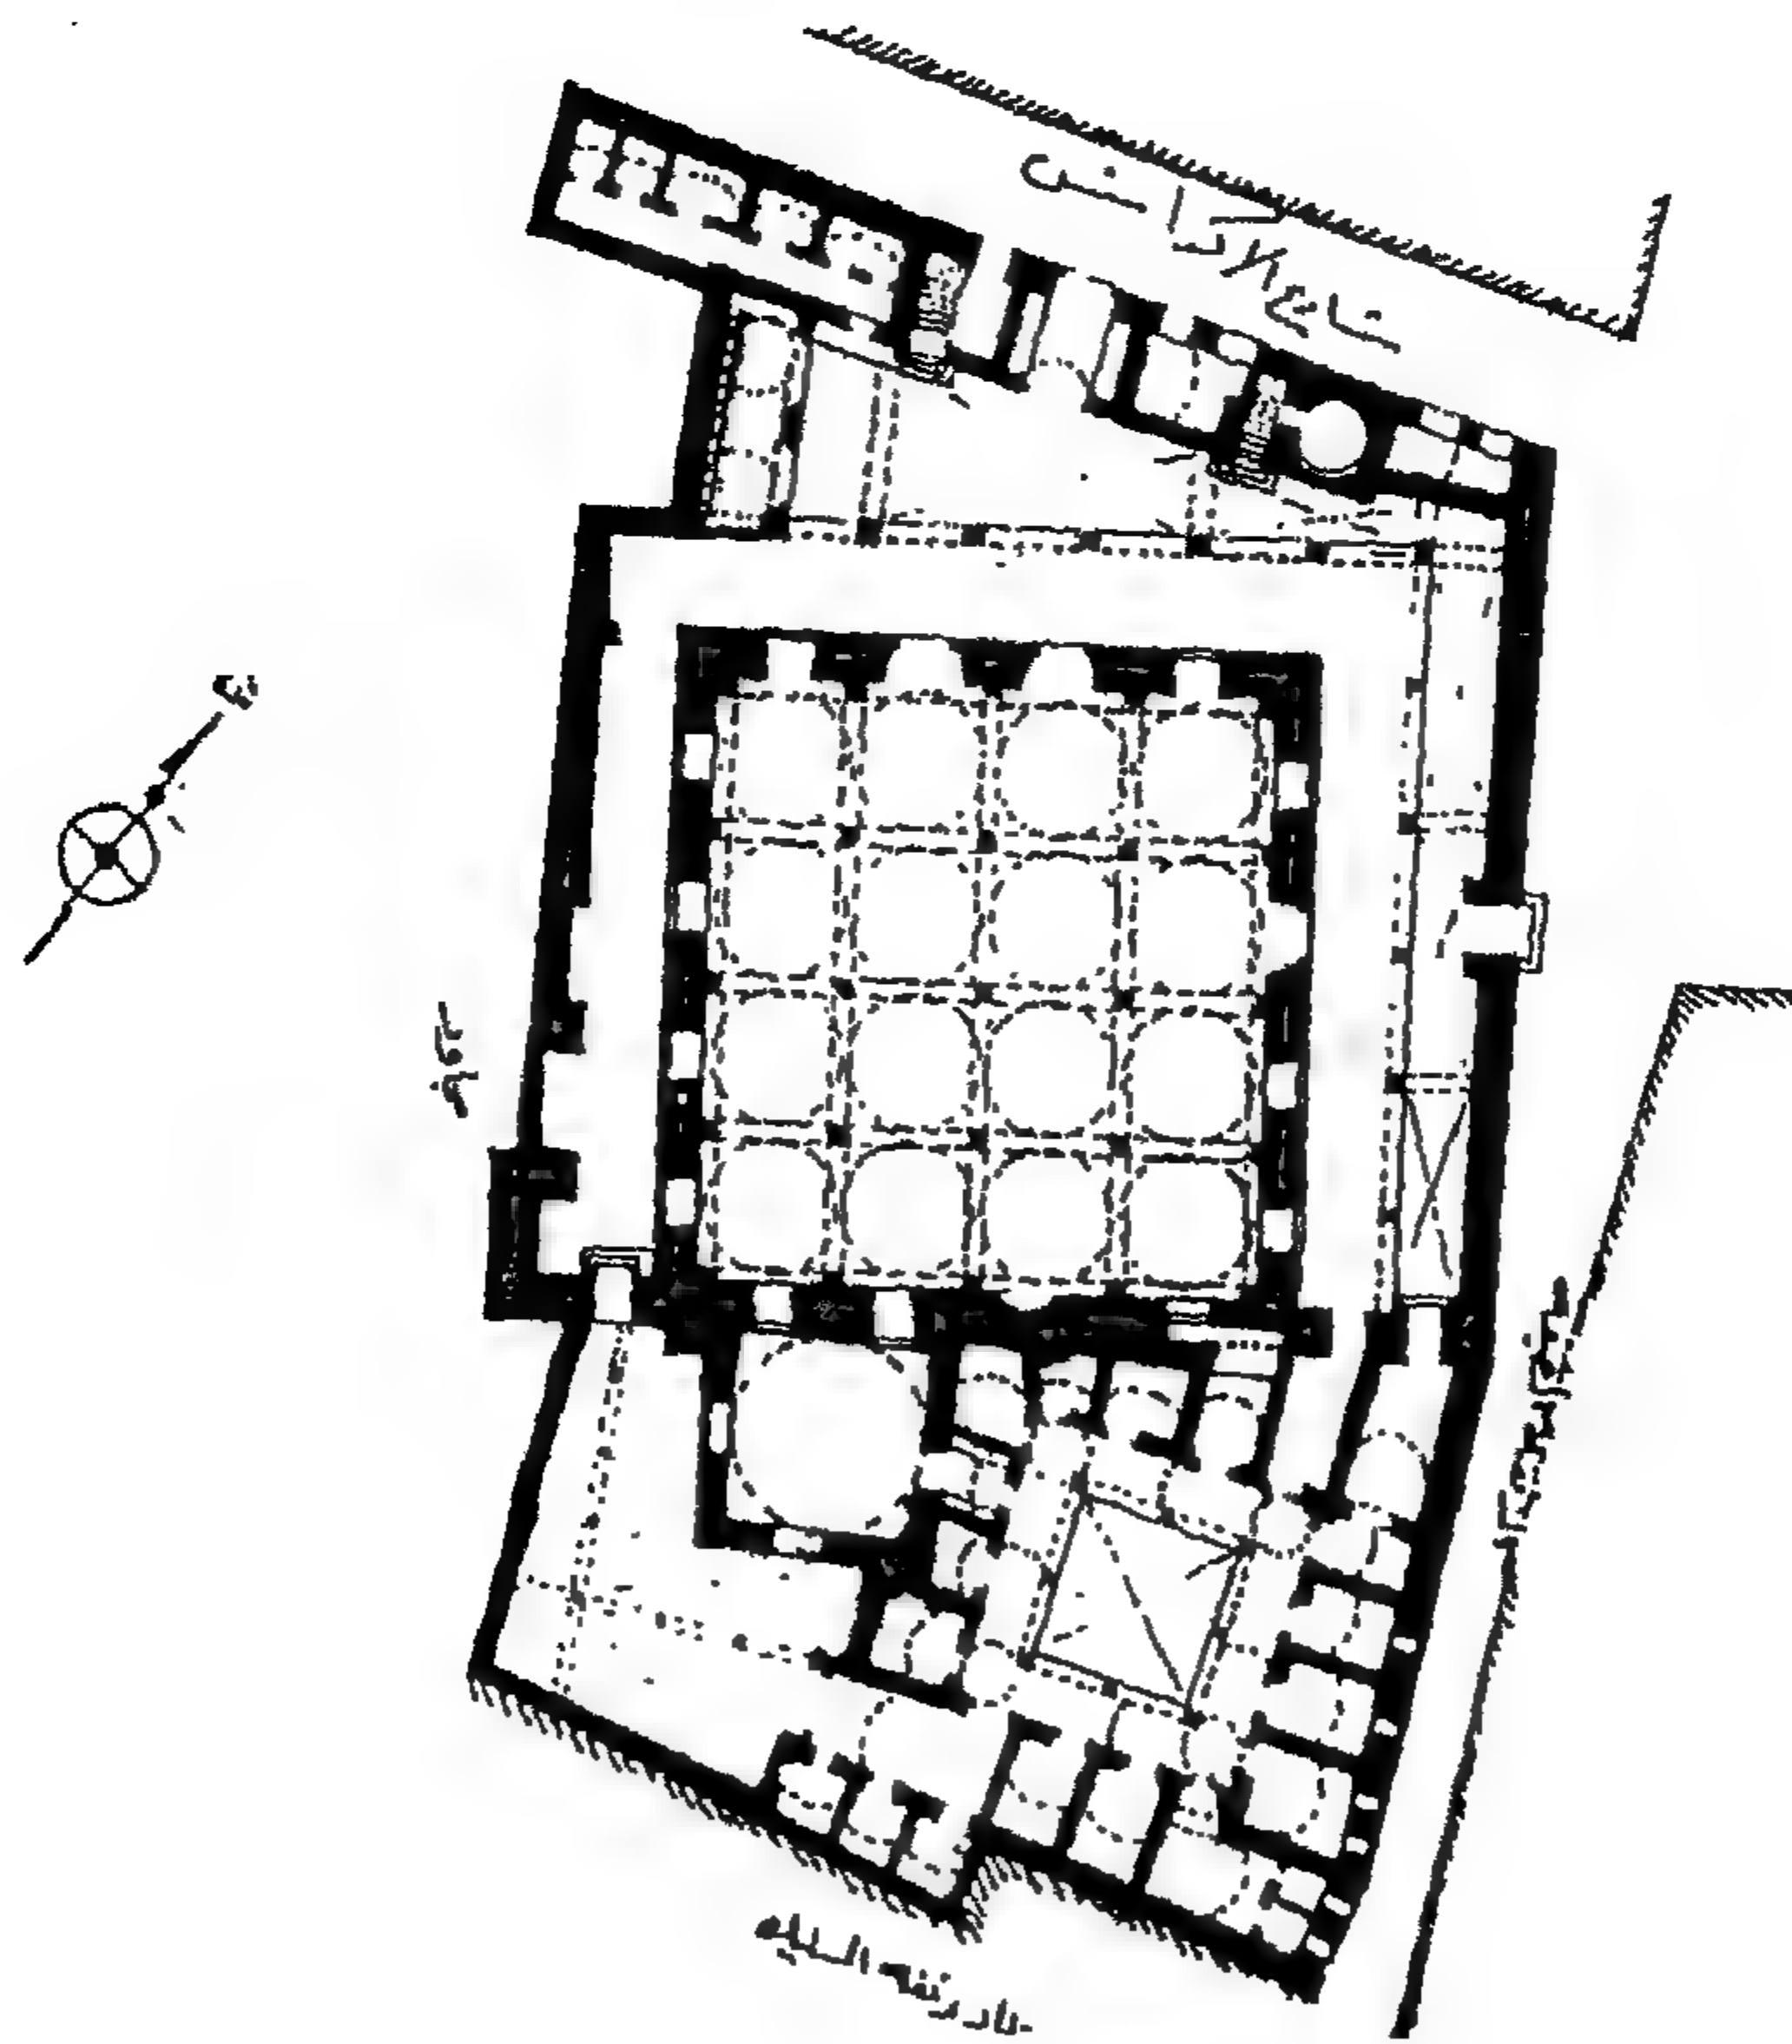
مسقط أفقي للمدرسة البوعنانية بفاس. (عن : الكحلوي) .
